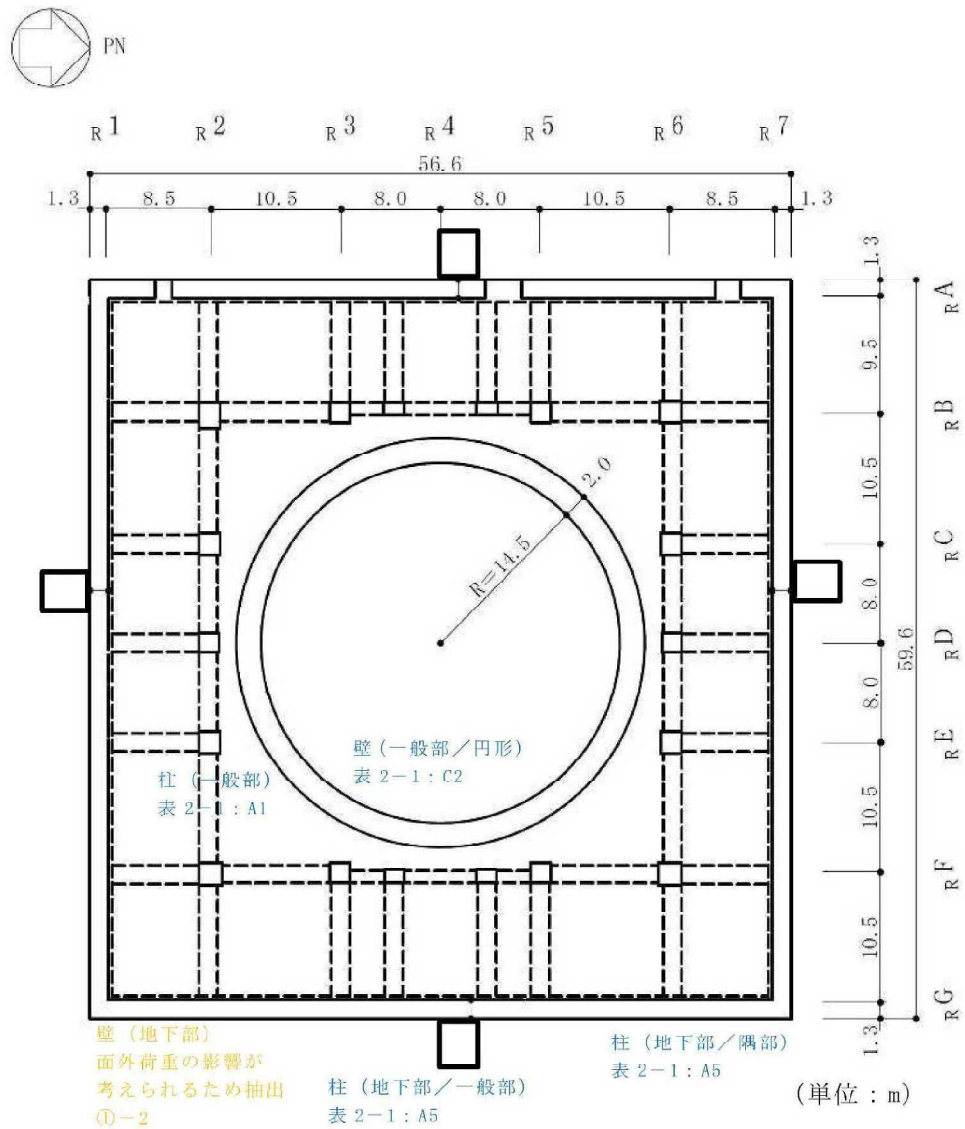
原子炉建屋の概略平面図 (B1F, T.M.S.L. 4.8m) (3/8)
